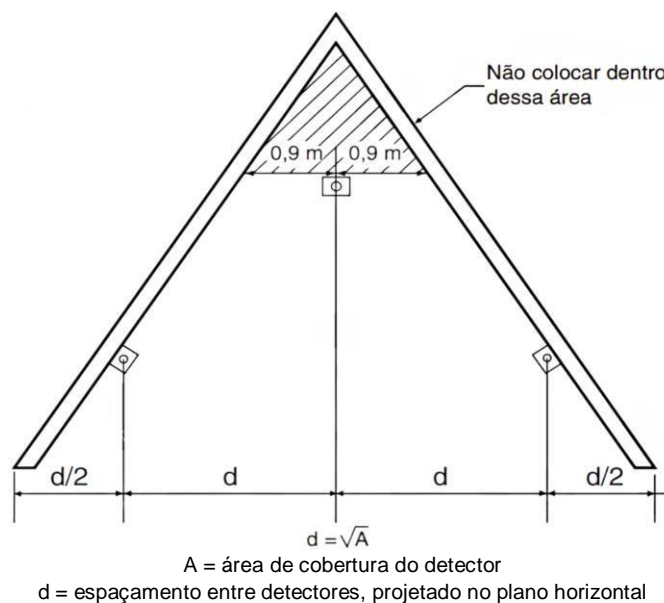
Distribuição de detectores pontuais de fumaça em planos inclinados, sem ventilação na cumeeira
